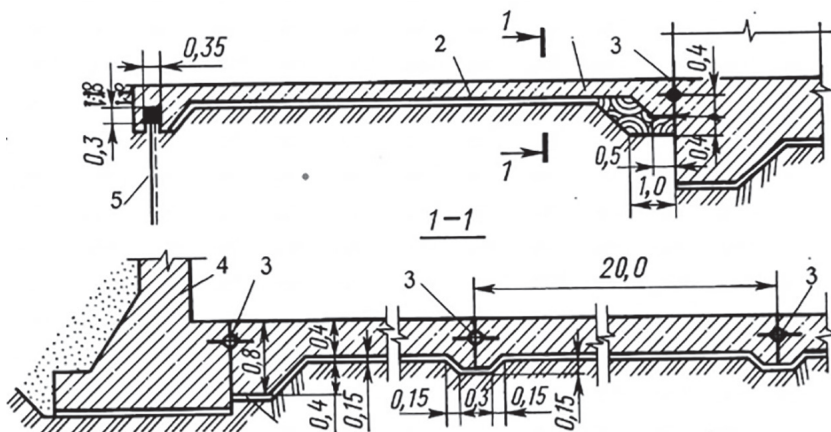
Esquema de una carpeta rígida de hormigón u hormigón armado
